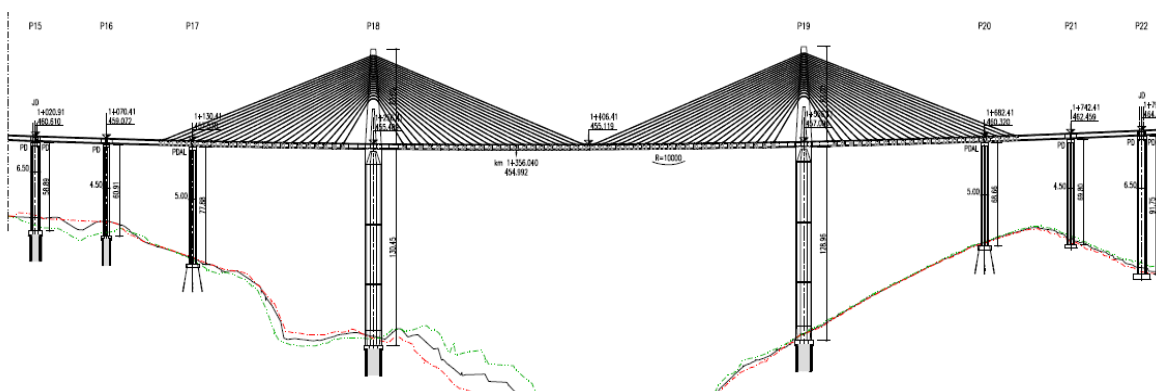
Corte longitudinal dos pilares P15 a P22 do projeto do Viaduto do Corgo (Barata, 2009)
